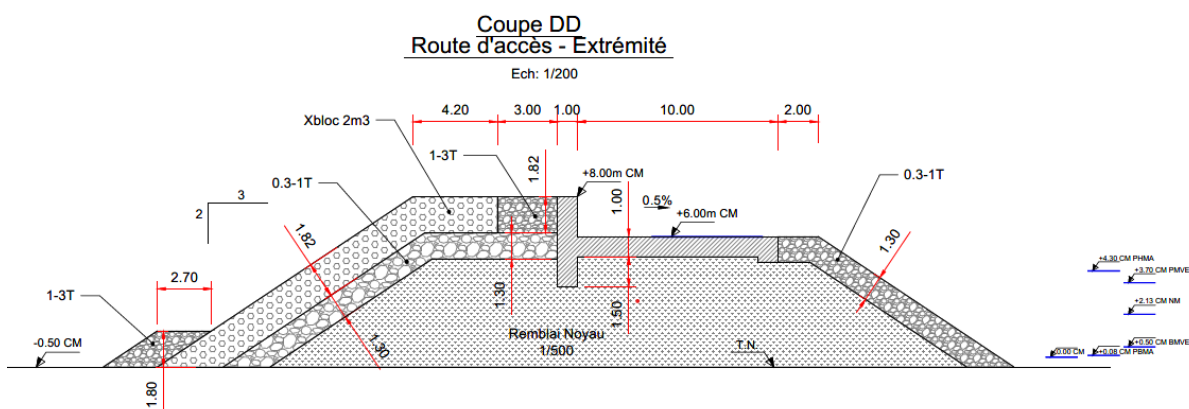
coupe en travers digue d'accès à la jonction route/quai
